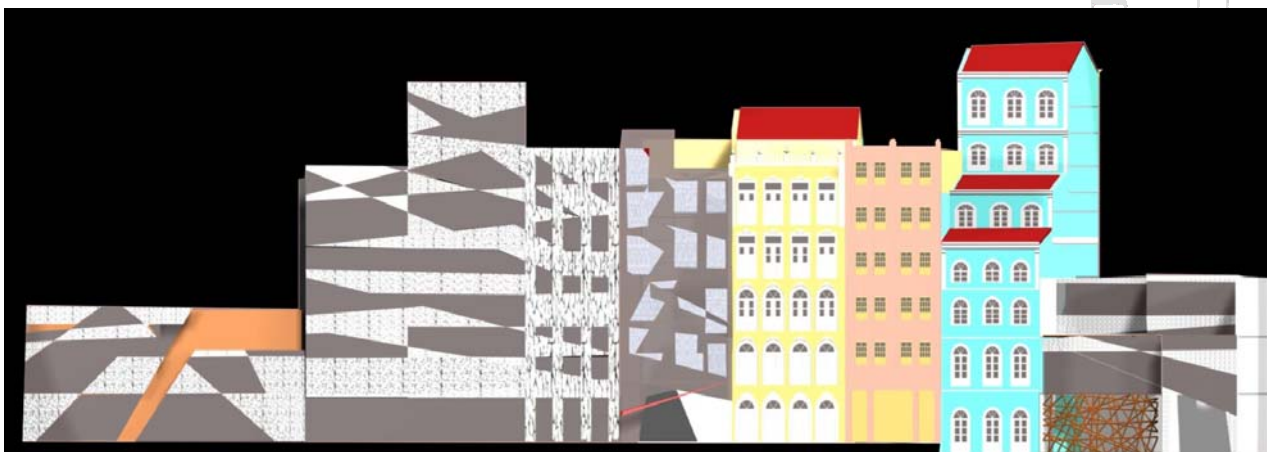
Fachada de outra proposta de adaptação do casario vizinho ao Elevador Lacerda em empreendimento hoteleiro, realizada pelos estudantes do curso – opção 1 do primeiro exercício. Esta equipe preservou integralmente apenas três dos sobrados, substituindo alguns e alterando a configuração de outros (Imagem gerada a partir de maquete virtual realizada pelos alunos do ateliê IV/2004).
